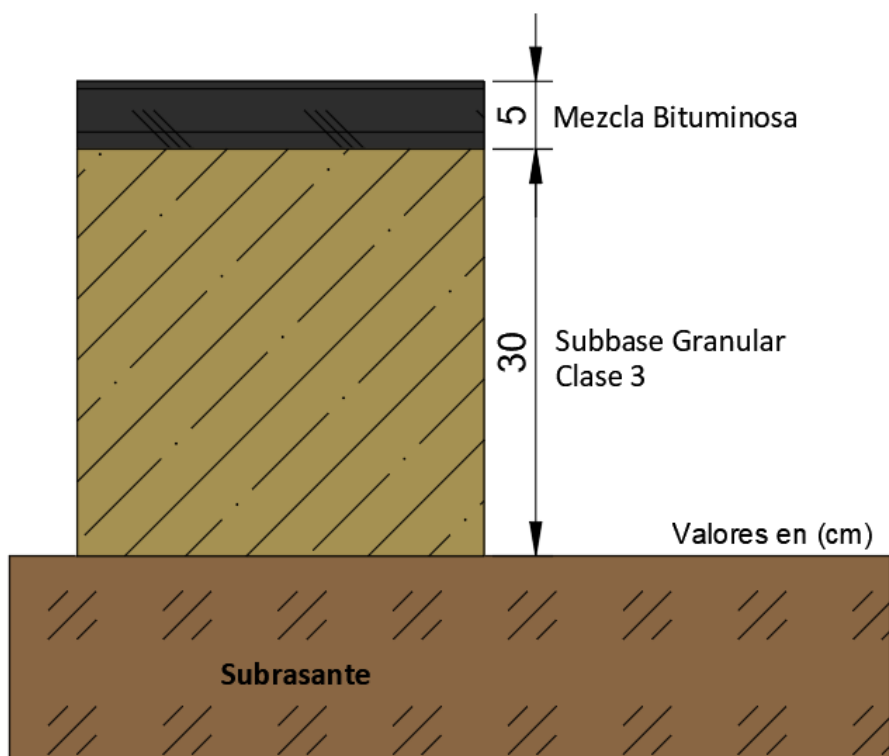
Estructura de pavimento modificada para las zonas sin empedrado de la vía CERCOPAMBA.
